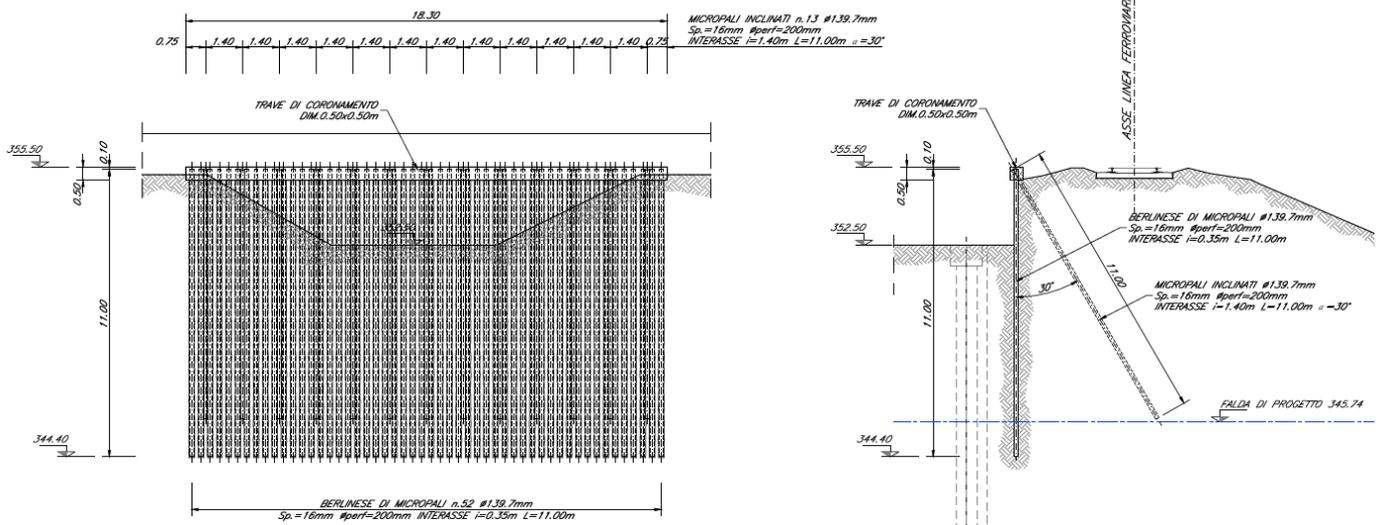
Opere provvisionali Spalla B Paratia a cavalletto
